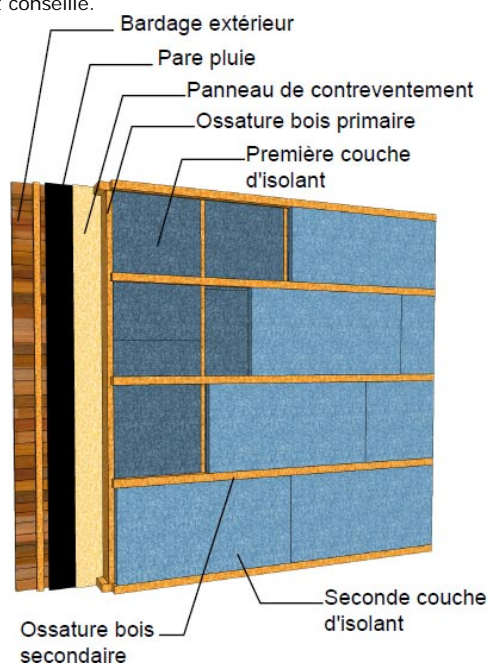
Pose d'une seconde couche d'isolant en isolation intérieure de mur en construction ossature bois
